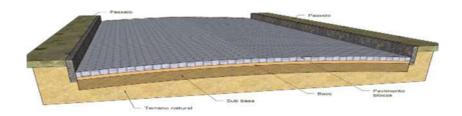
Desenho esquemático do perfil transversal da pavimentação com blocos
